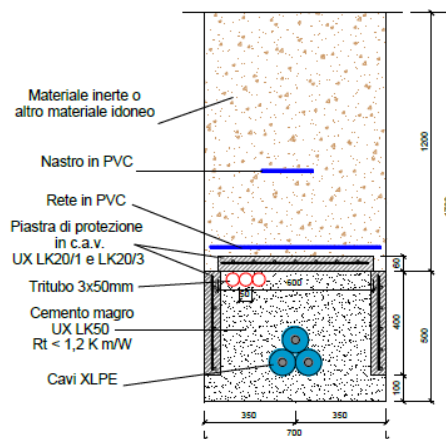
Sezione di scavo per cavidotto AT su terreno vegetale
